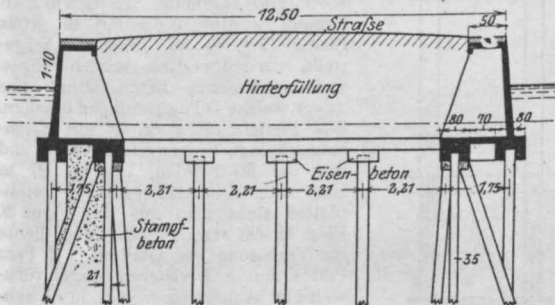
Verbindungsdamme. Schleuse bei Utrecht.
